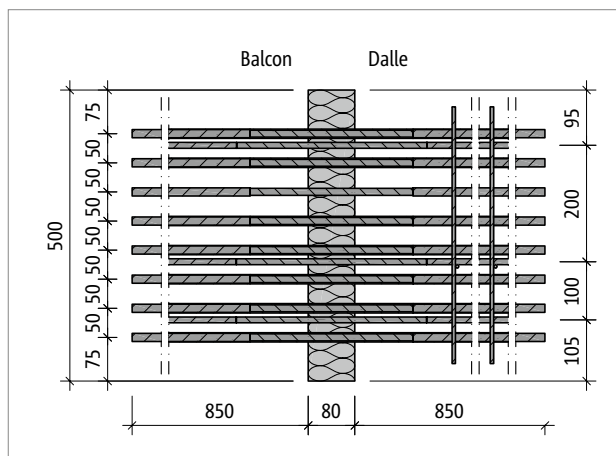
Schöck Isokorb® T Type K-M14-V1 : Plan de base du produit
